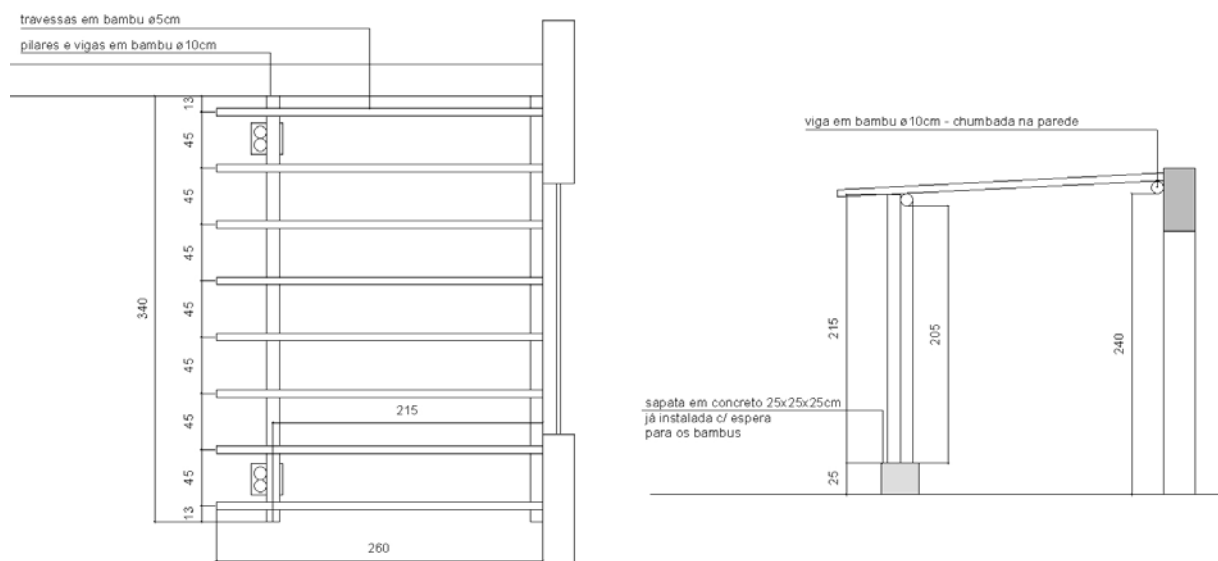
pergolado em bambu coberto com policarbonato – planta baixa e vista lateral
